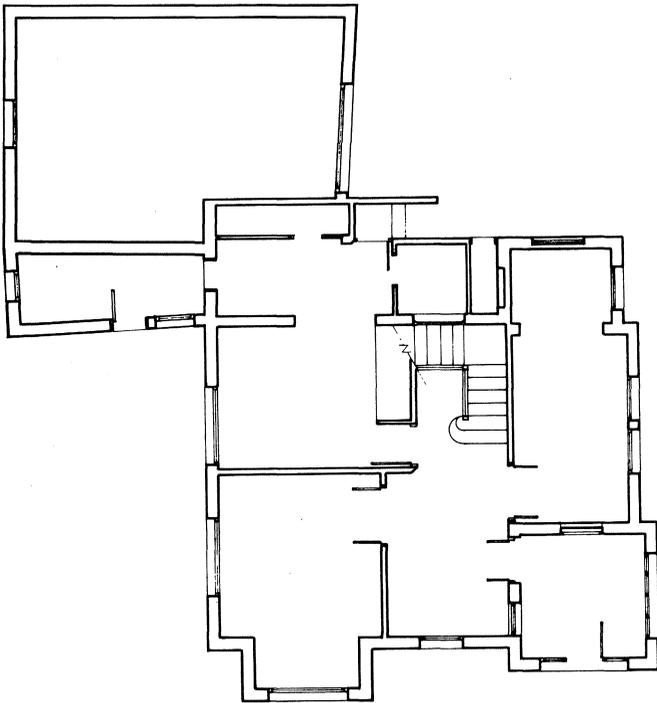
VIVIENDA UNIFAMILIAR EN VIGO - PLANTA BAJA (estado inicial).
